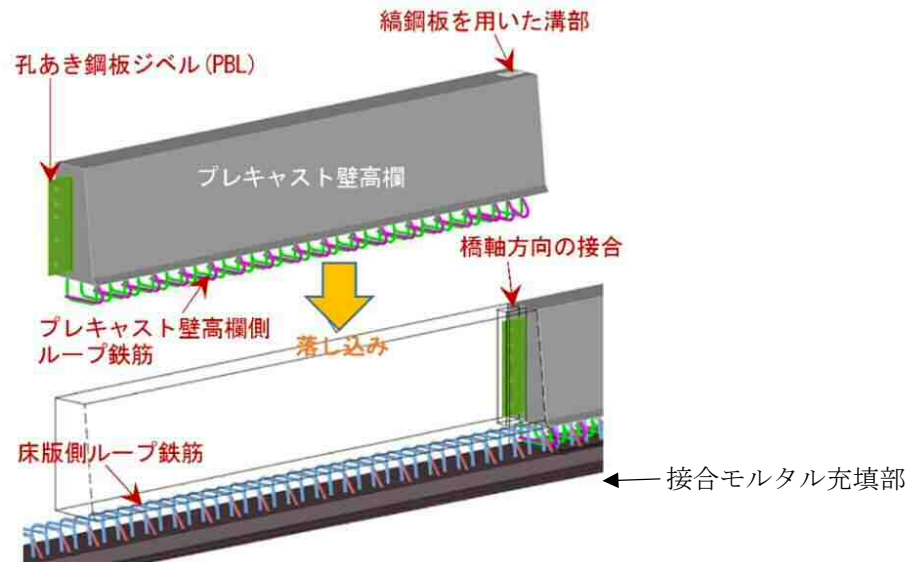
DAK 式壁高欄の構造と鉄筋継手方法
